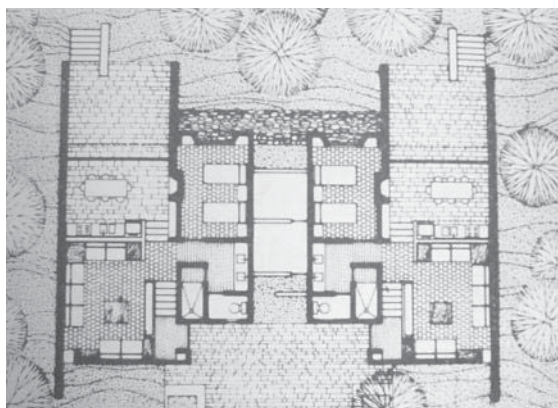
Planta de cabaña tipo 1, Los Azufres, libro
